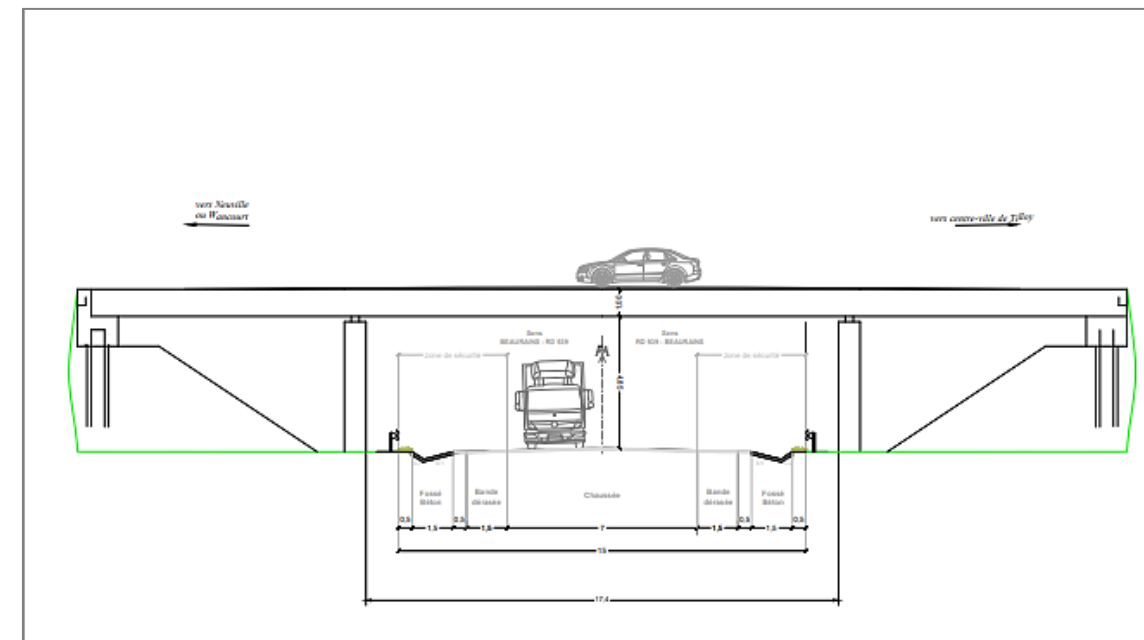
Profil en travers du futur contournement routier sous les ouvrages d'art de la rue de Neuville et de la RD37E1
